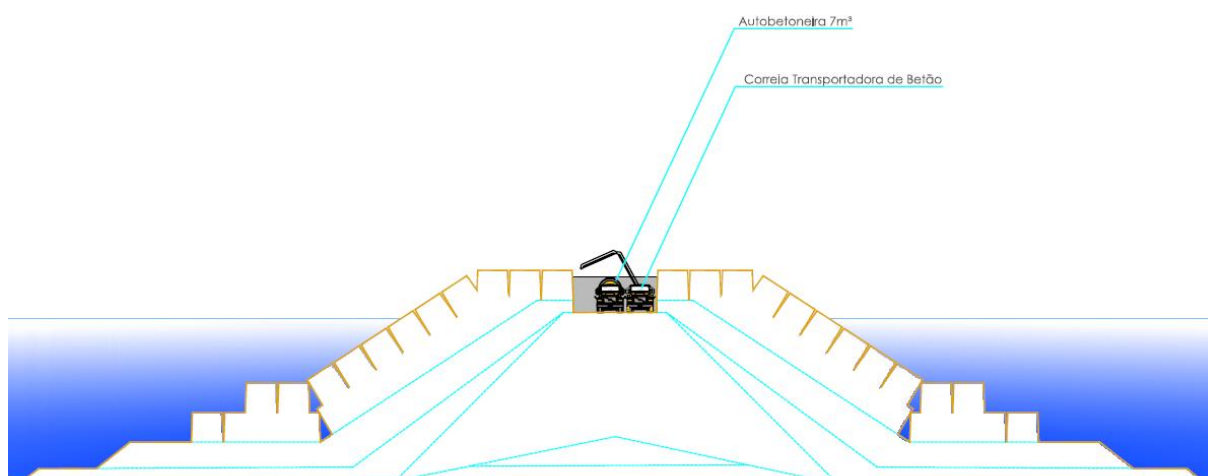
Betonagem no maciço de coroamento, esquema em corte longitudinal. (ETERMAR – Engenharia e construção S.A.)
